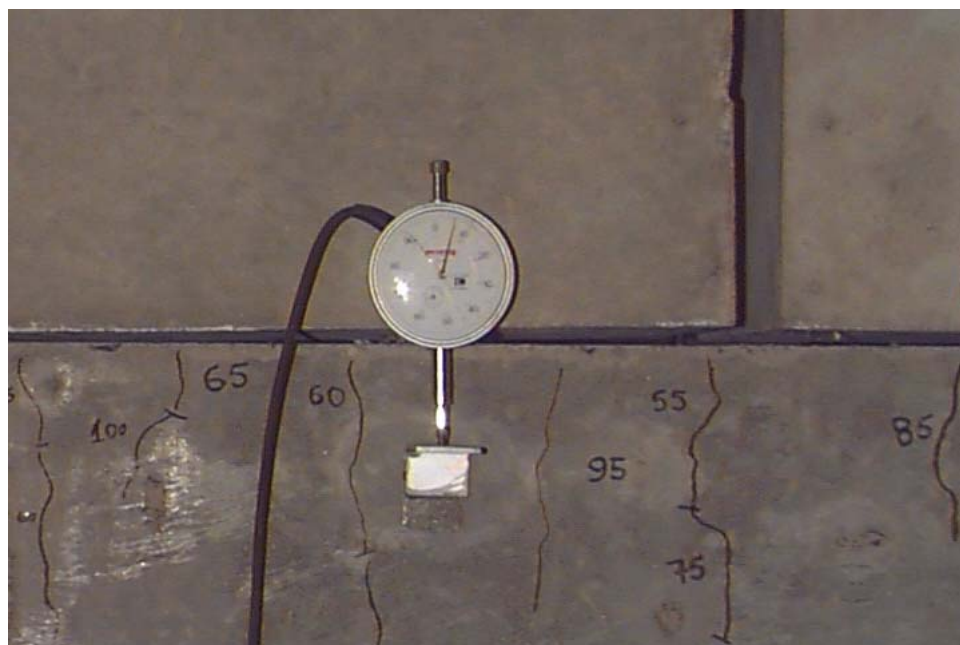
Separação da junta viga-consolo (ampliação).
